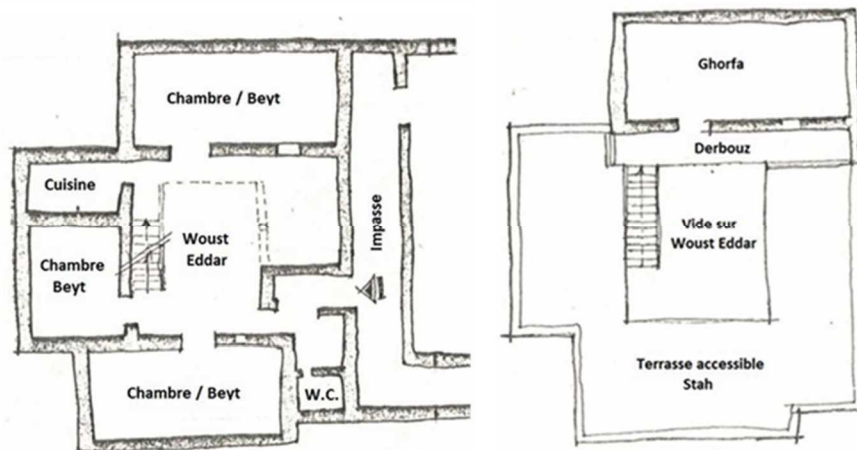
Plan de RDC et de étage 01 d'un maison traditionnelle
